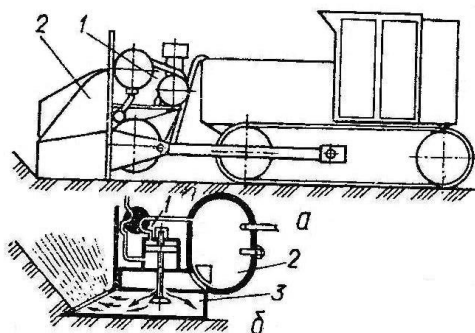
Бульдозер вибухової дії: а – схема машини; б – схема робочого органу; 1 – камера згоряння; 2 – компресор; 3 – вибухова камера
